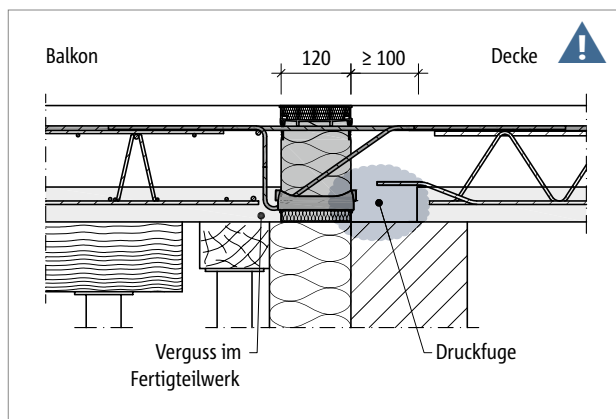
Schöck Isokorb® XT Typ K: Direkte Lagerung, Einbau in Verbindung mit Halffertigteilplatten (hier:  $h \leq 180$  mm), Druckfuge deckenseitig
